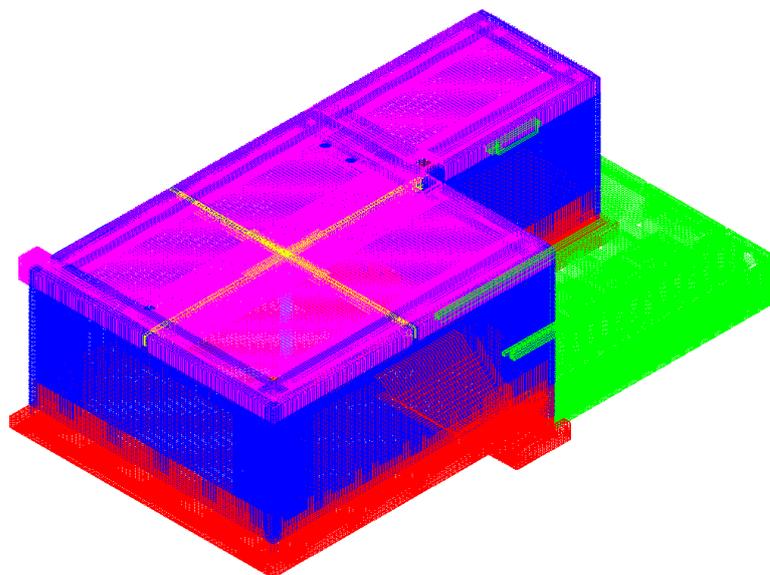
Recurso a código de cores para distinção das armaduras por tipo de elemento.
